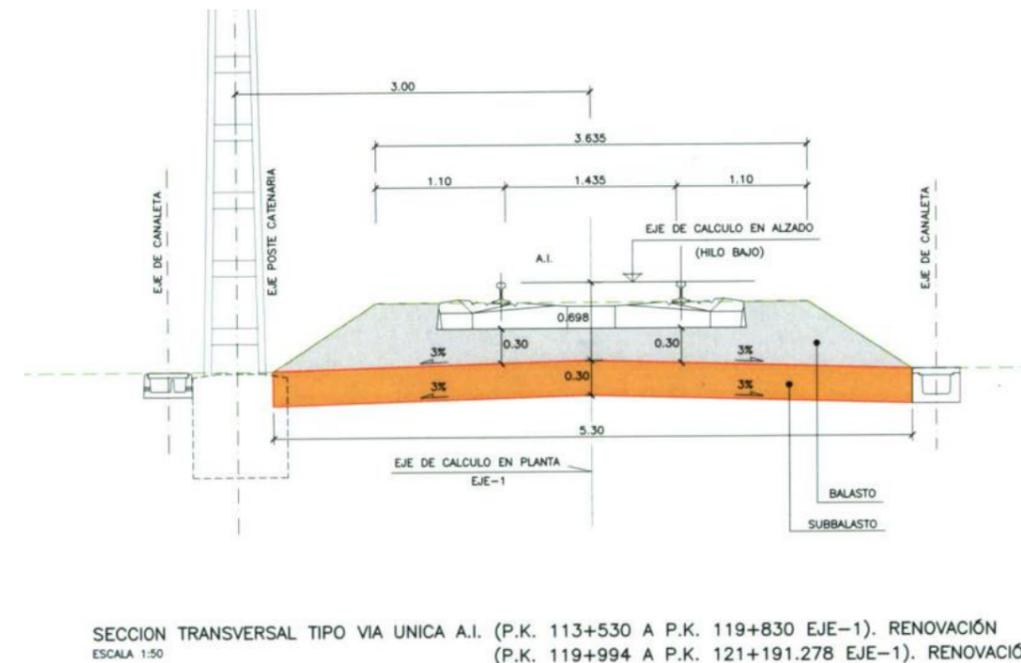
SECCIÓN TIPO DEL PROYECTO TORRELLANO – CREVILLENTE (RENOVACIÓN DE VÍA)
